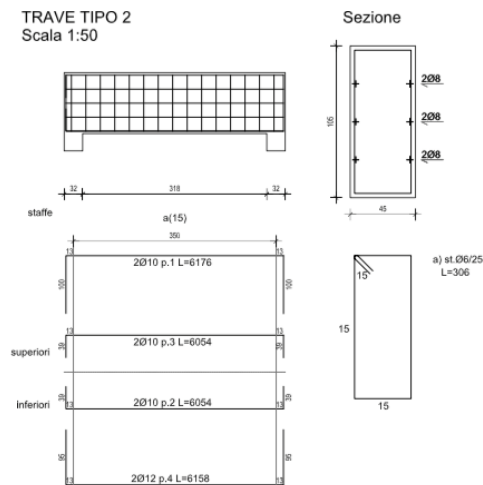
Armatura longitudinale e trasversale per trave secondaria di copertura.
